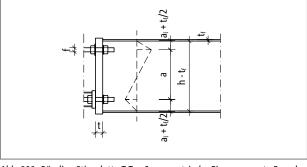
Bündige Stirnplatte T Typ S: geometrische Eingangswerte Berechnung; Ansicht
